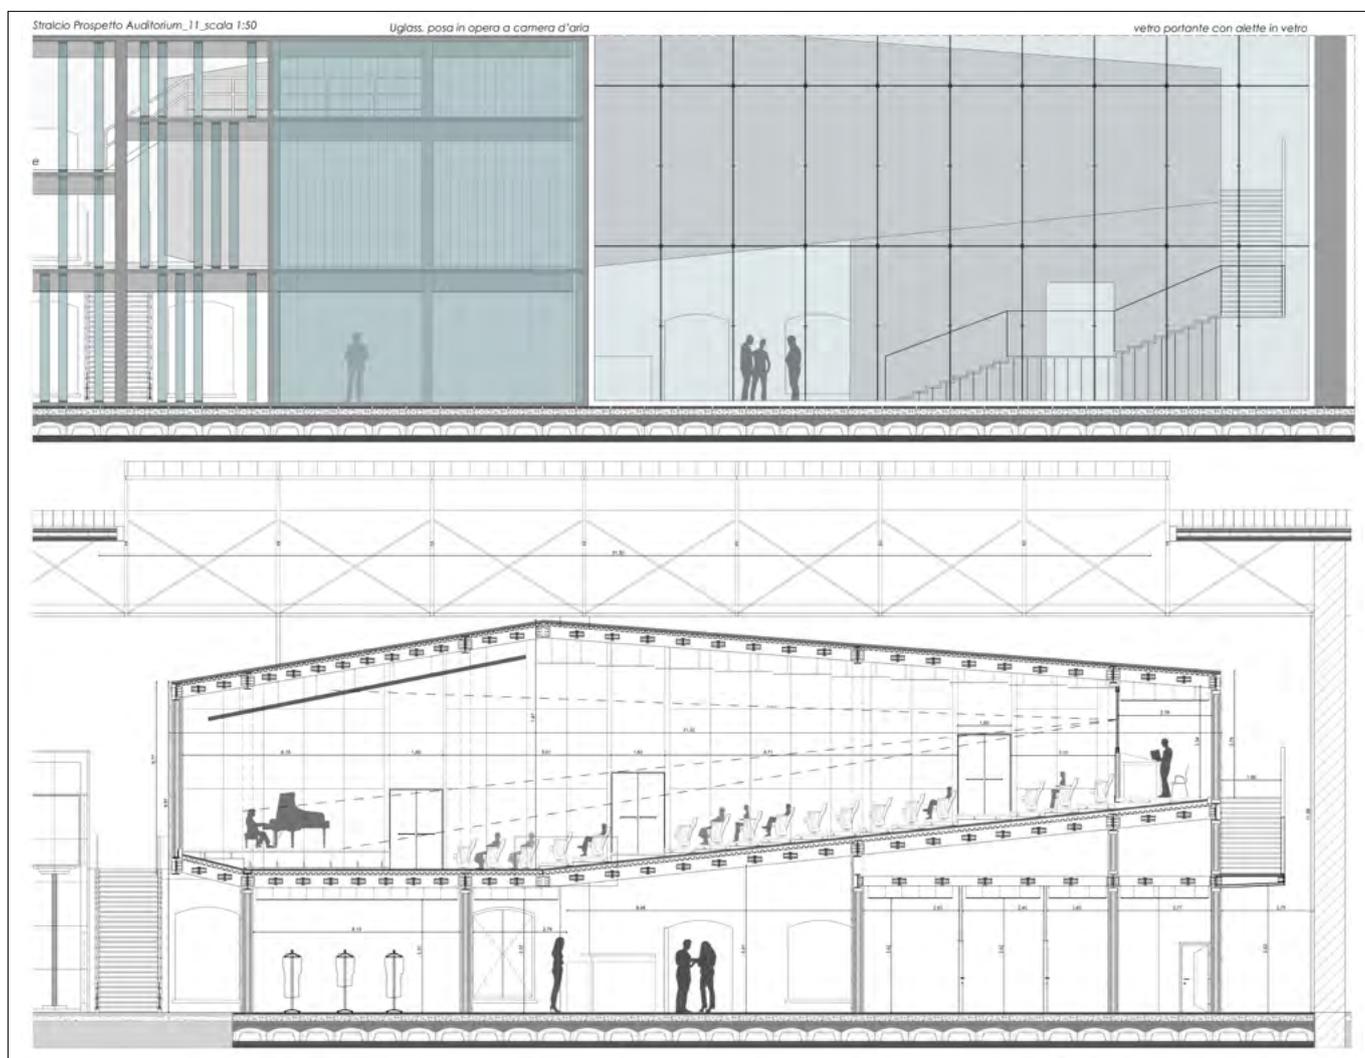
Dettaglio del prospetto e sezione dell'auditorium
